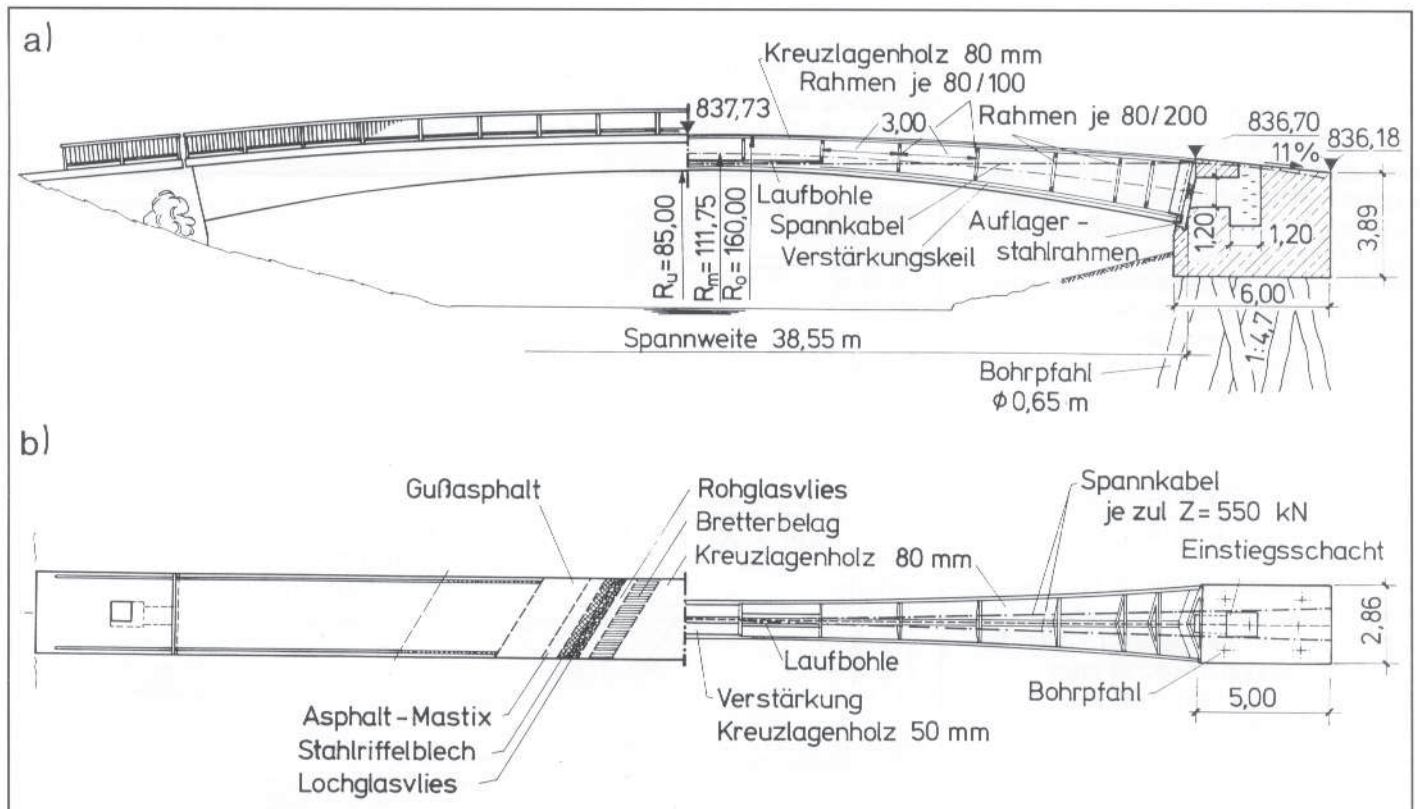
Brücke über die Ammer in Oberammergau, Übersicht
